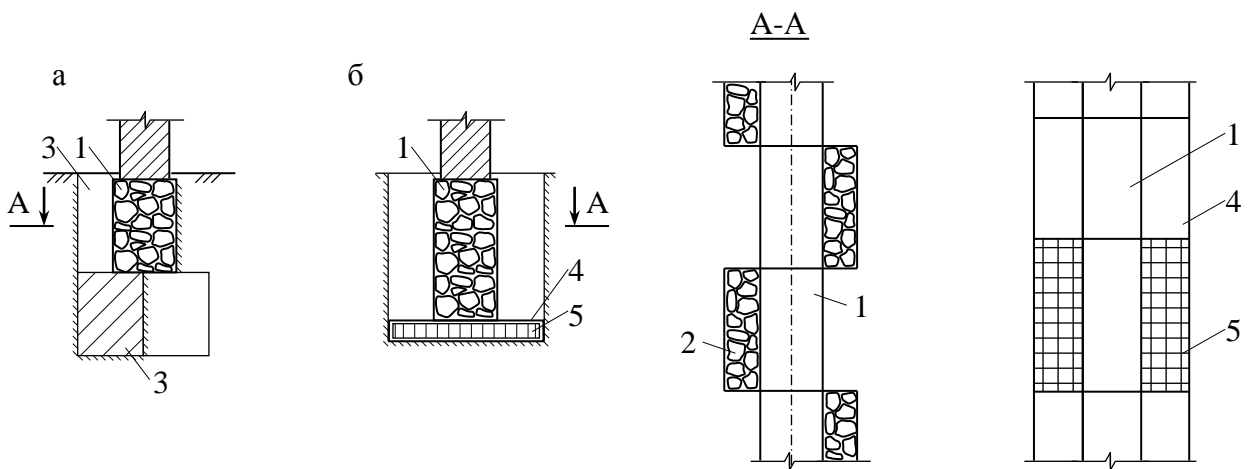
Конструктивні рішення підведення фундаменту: а – стовпи з шаховим розміщенням у плані; б – залізобетонні плити; 1 – фундамент; 2 – стовп; 3 – шурф; 4 – плита; 5 – арматурний каркас
